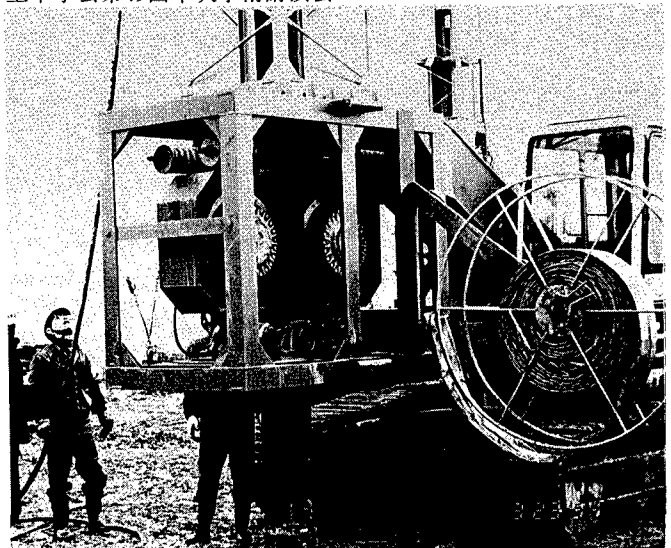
クロス（十字型）ドレーンの打設施工実験の概要
